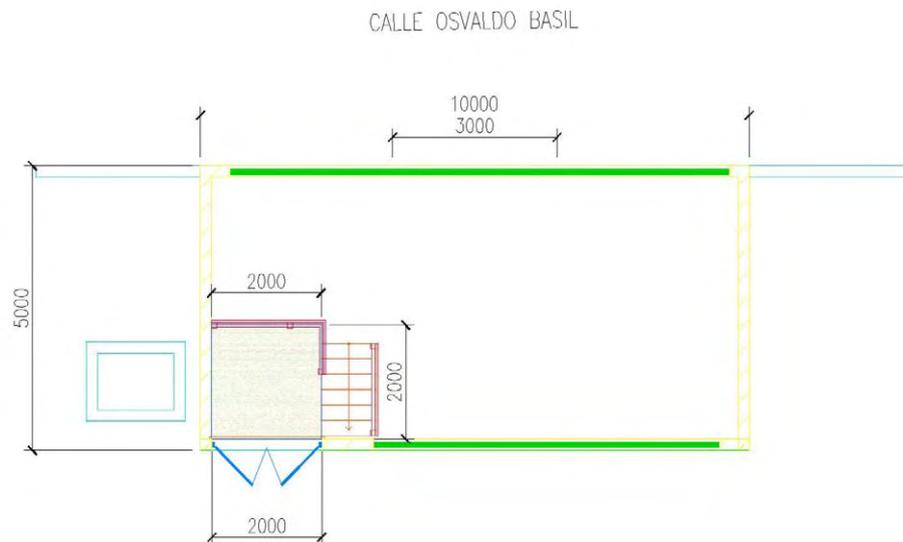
Planta Arquitectónica para el Almacenamiento para Desechos Comunes en el Parqueo de Quemados (Unidades en mm)
